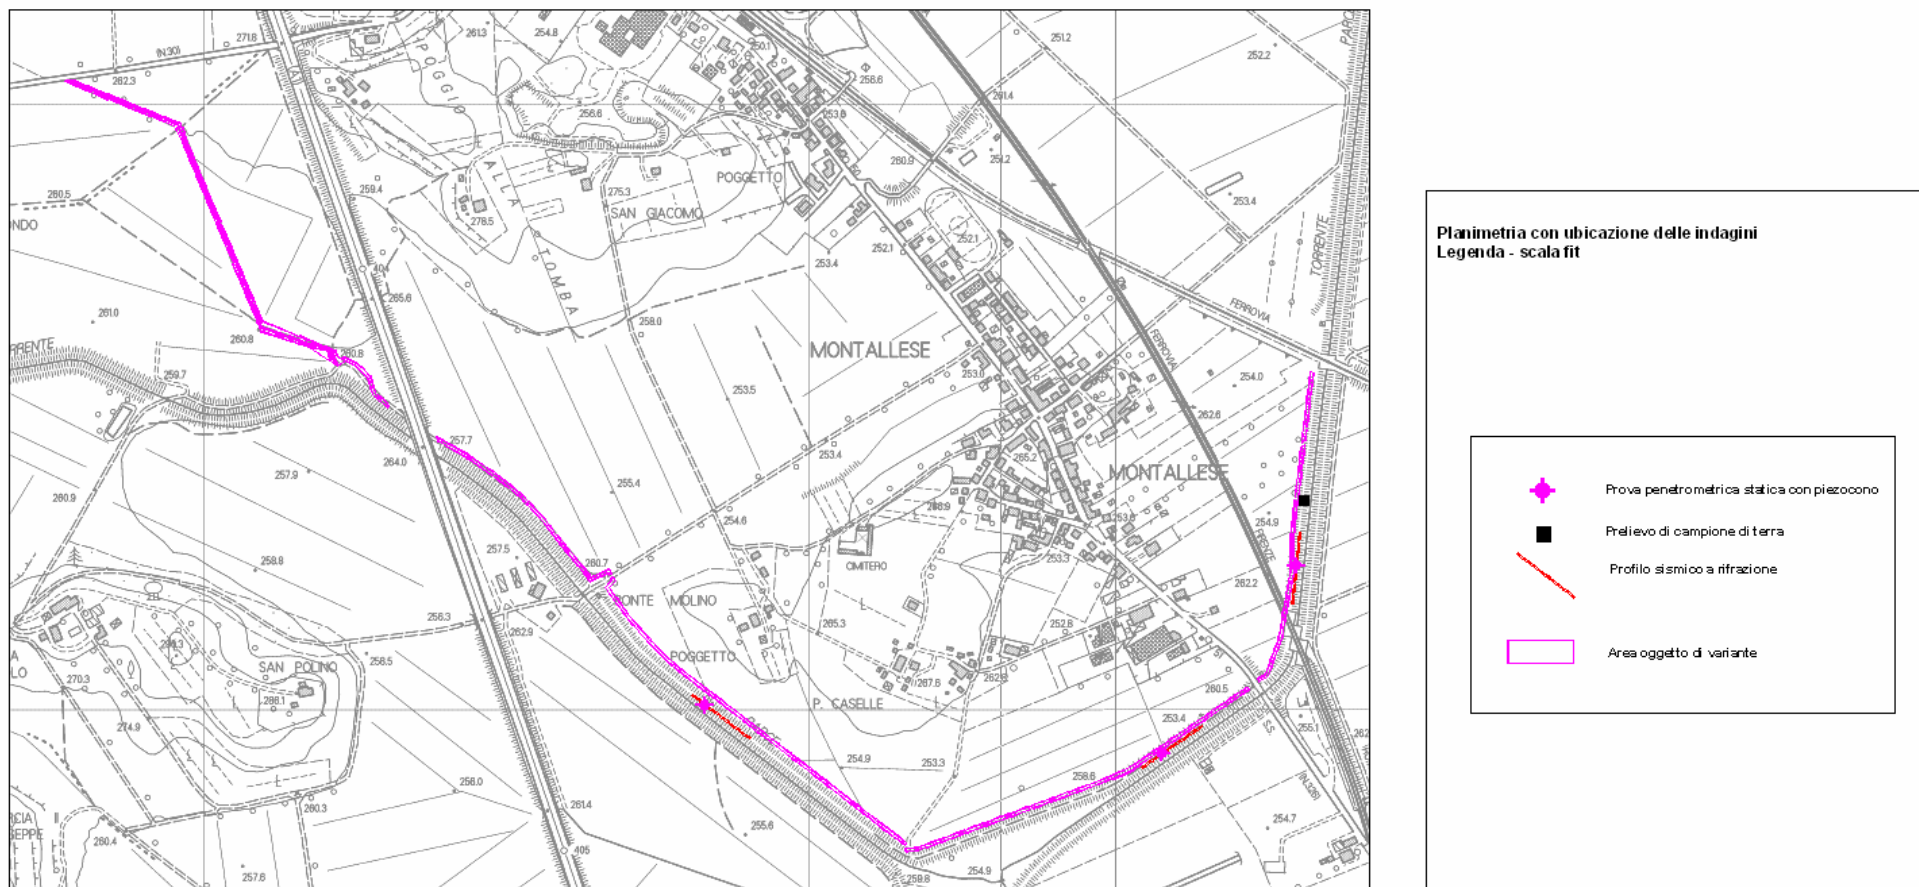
Planimetria generale con ubicazione delle indagini (scala fit)
